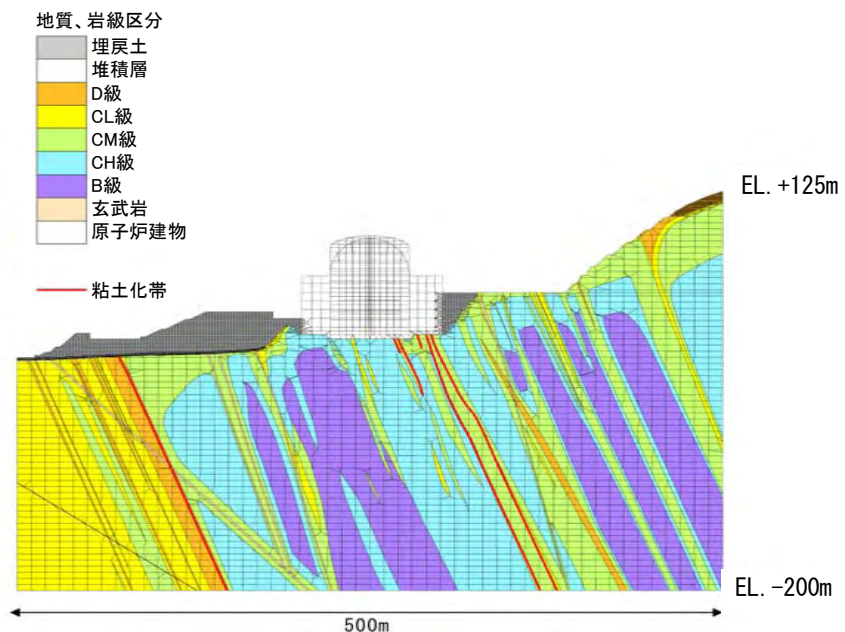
(1) 原子炉建物基礎地盤の解析モデル図
